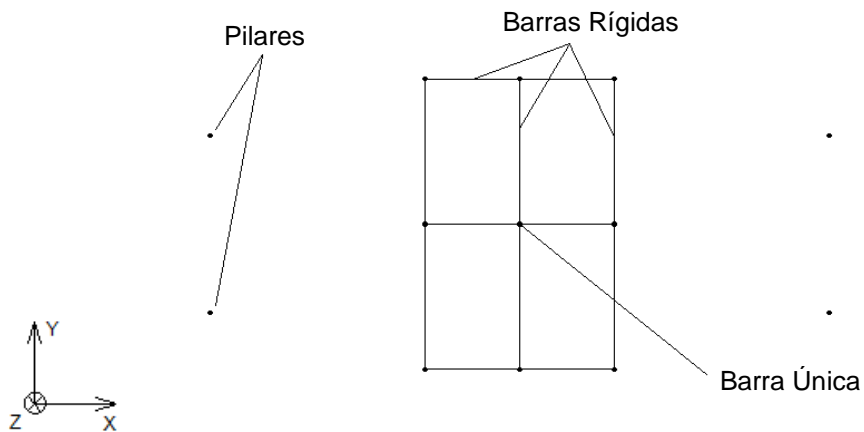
Vista em planta, a partir do 37º piso, do núcleo central sem aberturas e dos pilares laterais
